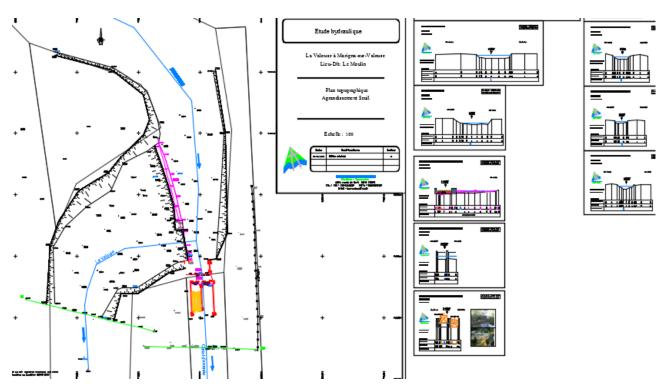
Plan masse de l'ouvrage, profils en travers et coupes
